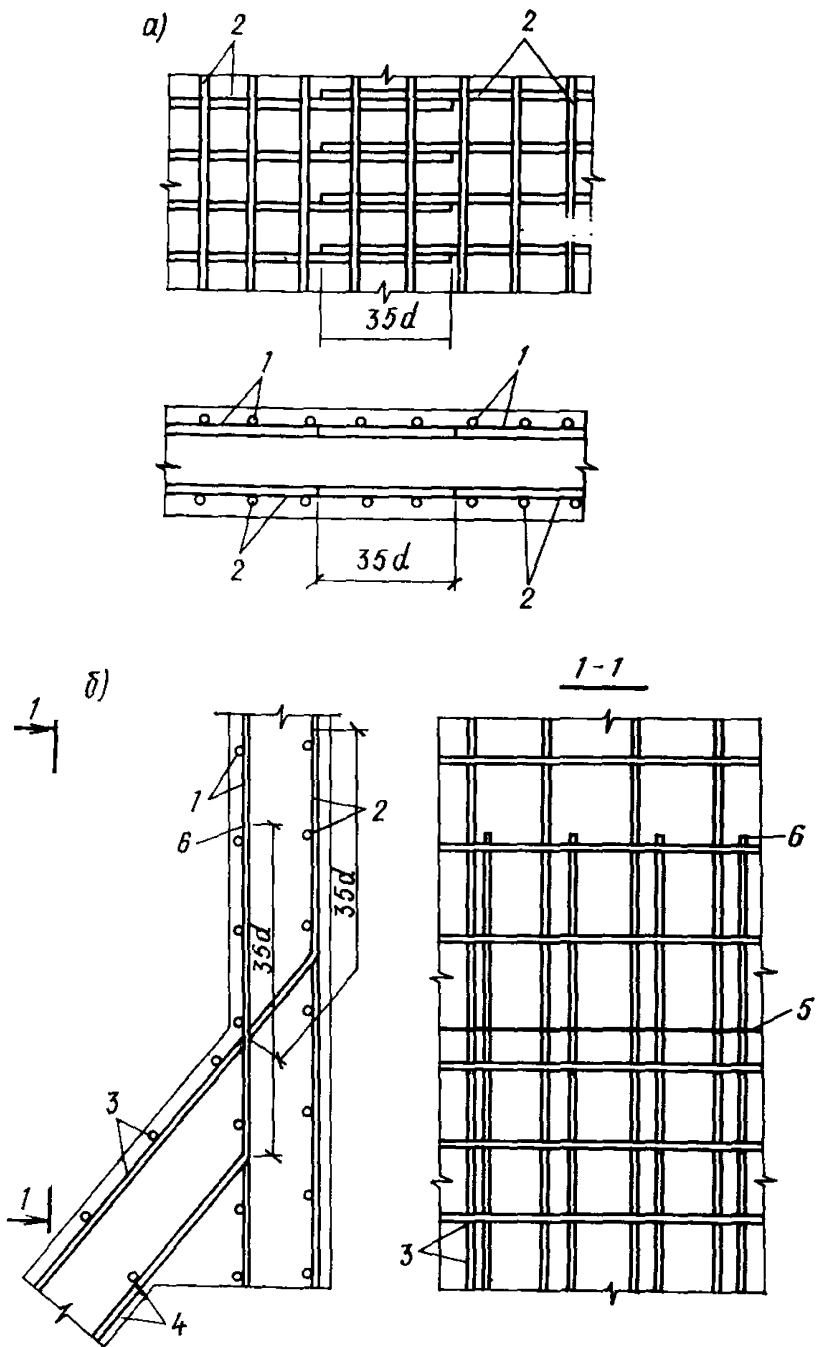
Армирование монолитного бункера сварными сетками.
